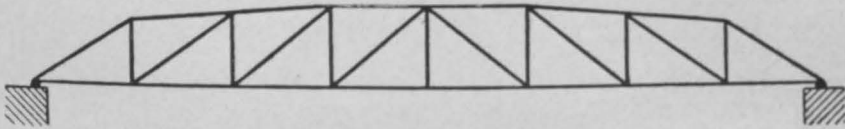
Deutsche Fachwerkbrücke aus dem 16. Jahrhundert.
